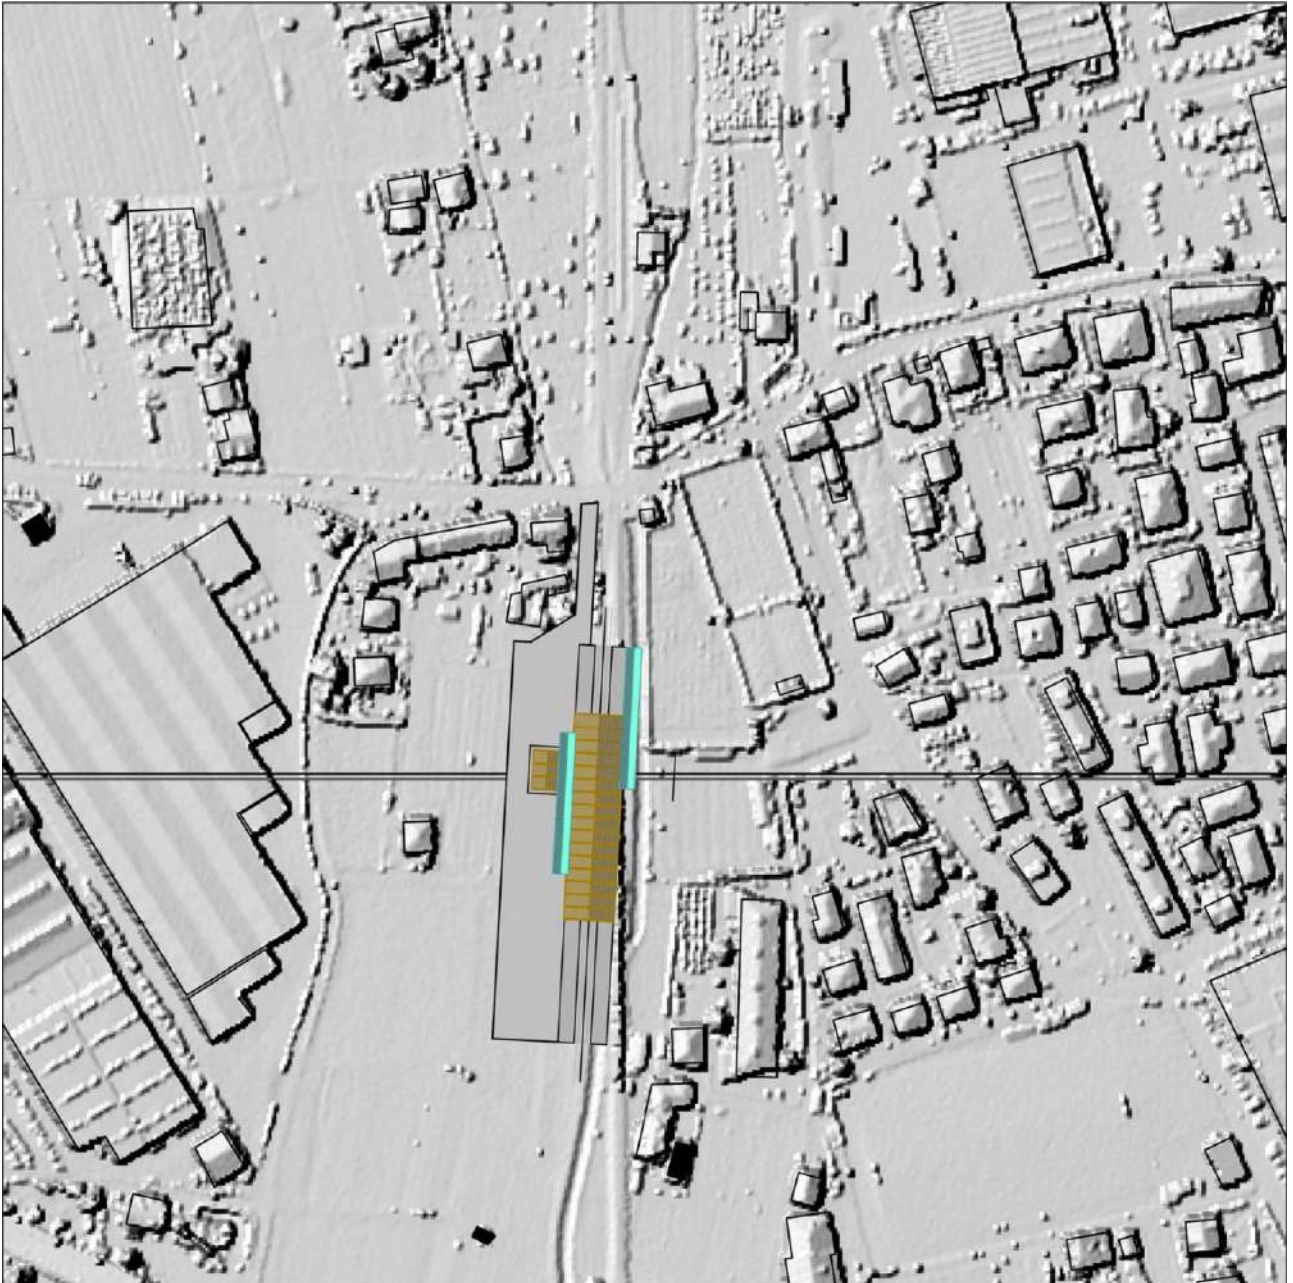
Gardolo: Planimetria generale con indicazione delle aree di parcheggio
